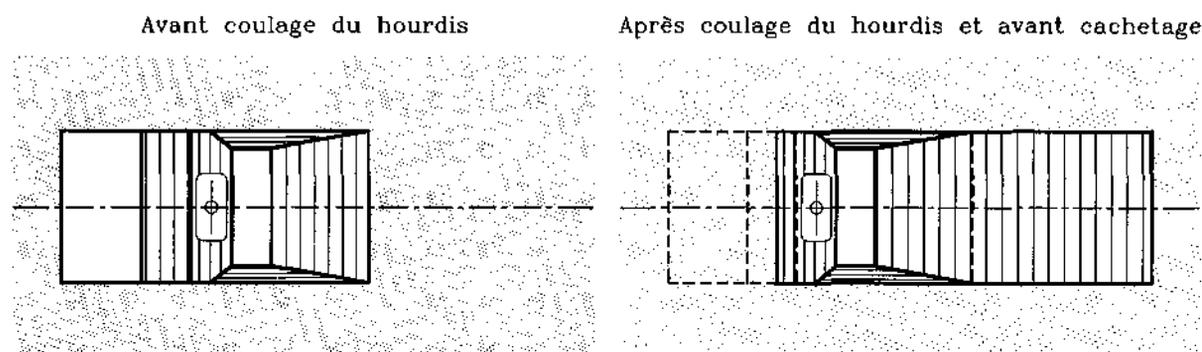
Principe d'une encoche de câble relevé dans le cas d'un hourdis général
